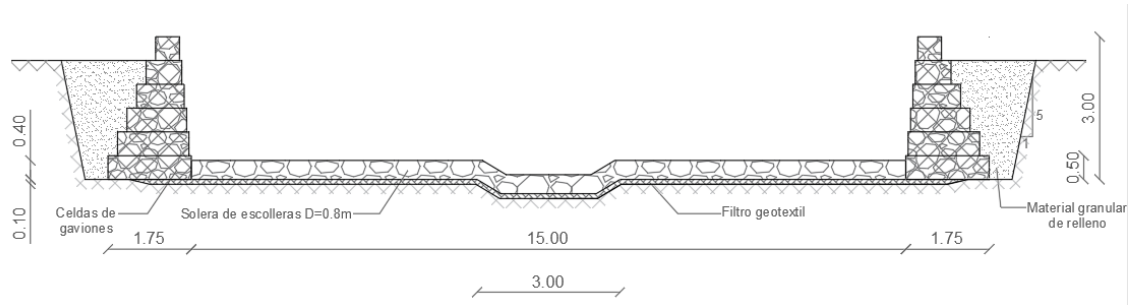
Sección propuesta para el tramo I del encauzamiento. FUENTE: Elaboración propia.
